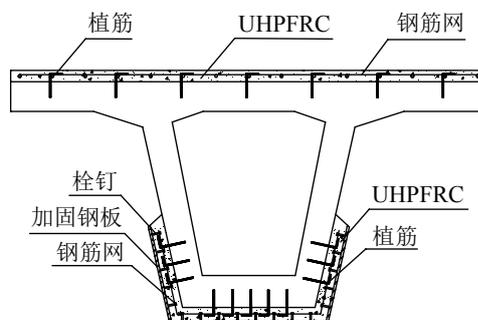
装配式预应力混凝土组合箱梁抗弯加固构造示意
